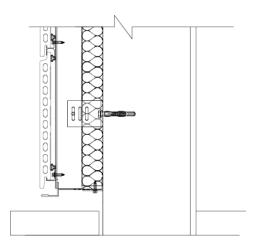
Kit Tempio® FS. Arranque de fachada.
